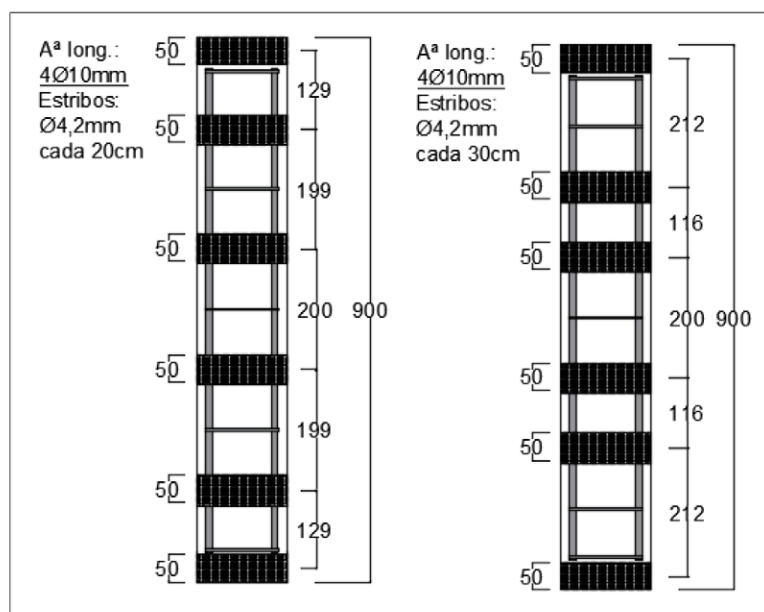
Refuerzo con tejido de PRFC: ubicación y dimensiones de las bandas para a) columnas con separación de estribos 200m y b) columnas con separación de estribos 300 mm
